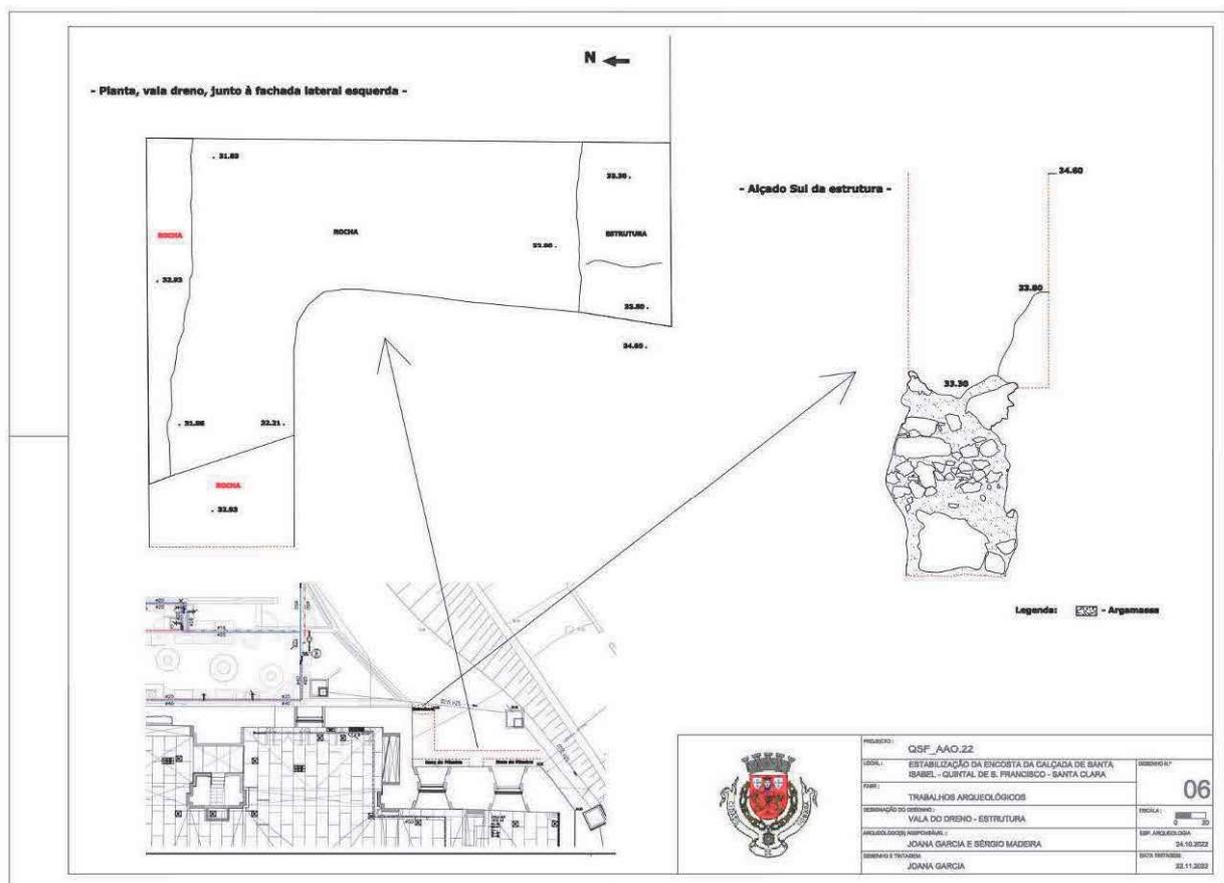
Registo gráfico: 1 – Planta parcial da vala para implantação do dreno, junto à fachada lateral esquerda; 2 – Alçado sul da estrutura rudimentar
